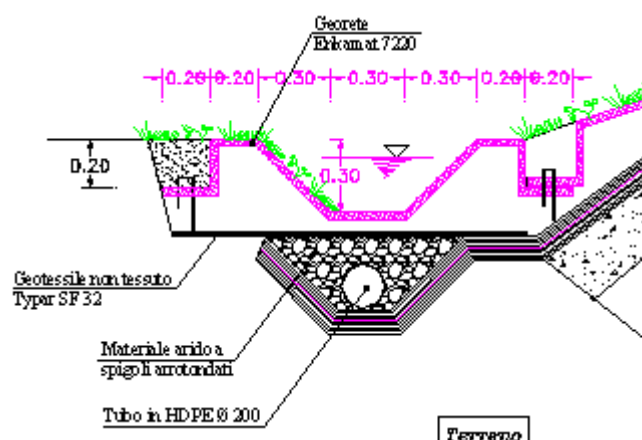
Particolare esecutivo della canaletta e della trincea drenante in sommità al muro in terra armata
